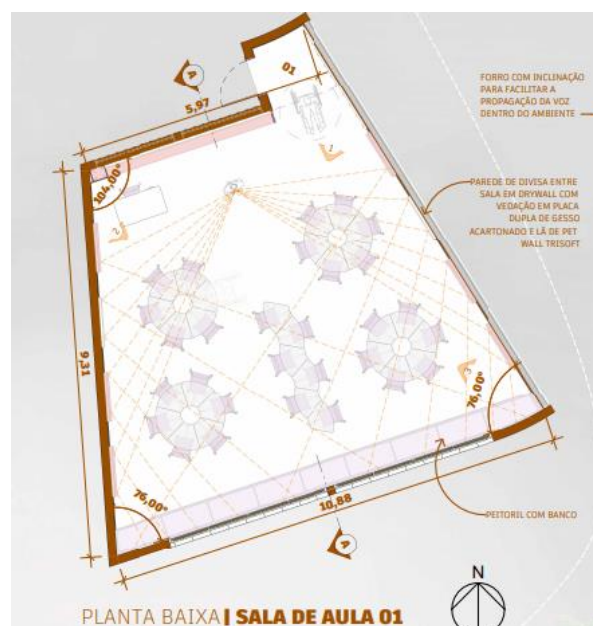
Planta Baixa da Sala de Aula 01 apresentando proposta de Layout e estudo de reflexão (Autores, 2023).
